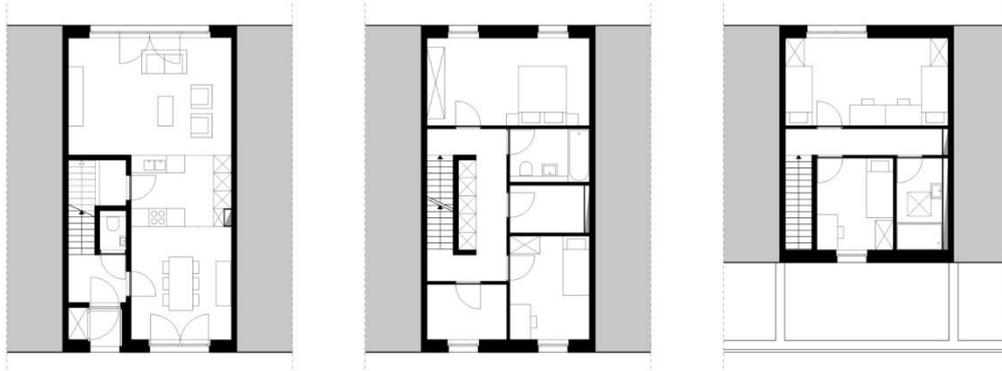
Planta baixa do térreo dos geminados dinâmicos
